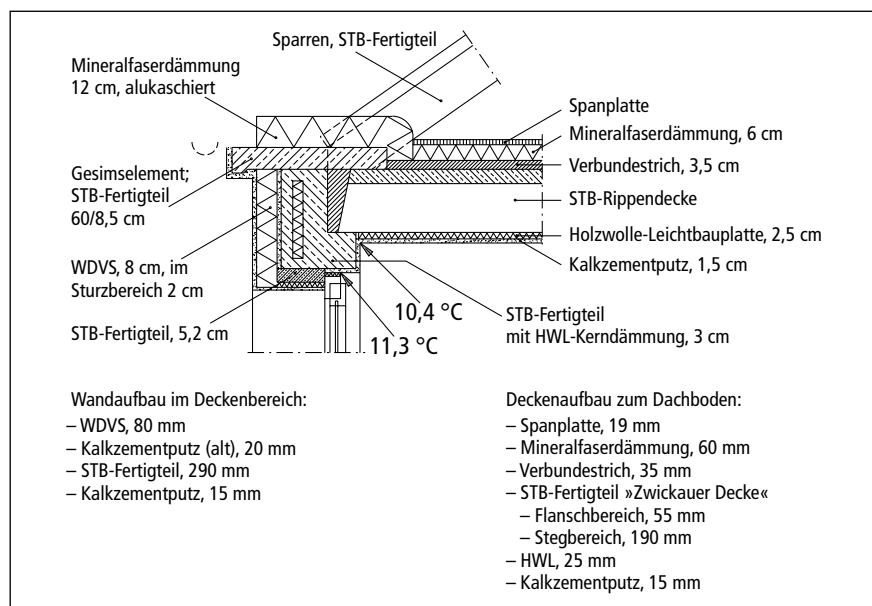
■ Konstruktionsaufbau im Bereich von Dachgesims (Sparrenwiderlager)/Deckenanschluss/ Fenstersturz und die errechneten, tauwasserunkritischen, minimalen Oberflächentemperaturen
